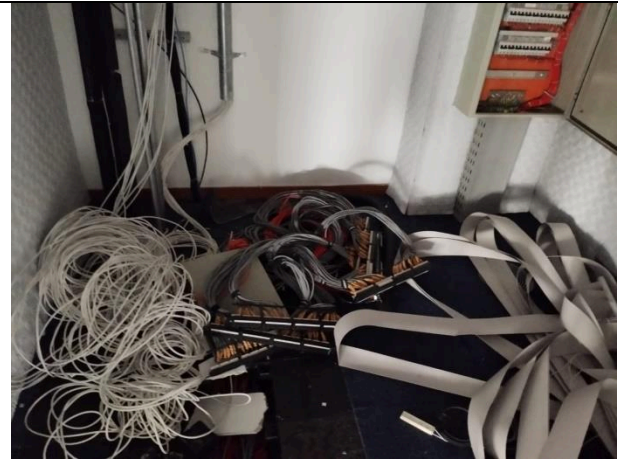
Torre 01 – 3º Pavimento – Retirada de cabeamento antigo de dados.
